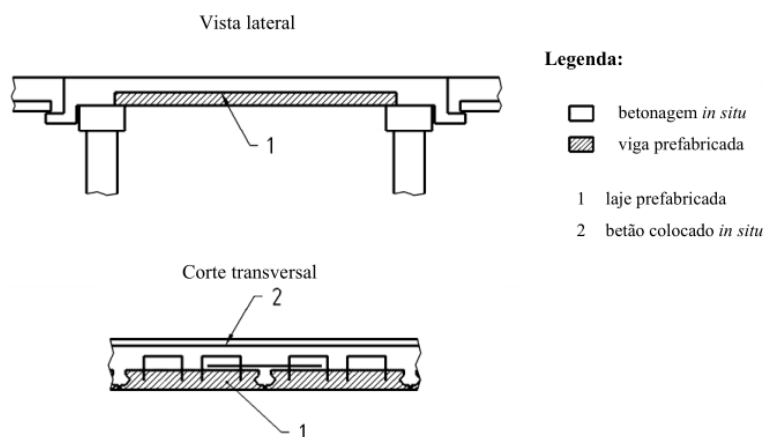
Ponte em laje maciça (NP EN 15050, 2008).
